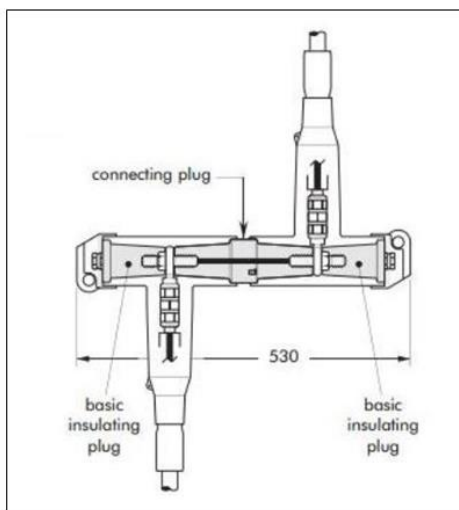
Dettaglio giunzione tra cavi MT all'interno del pozzettone di sezionamento
